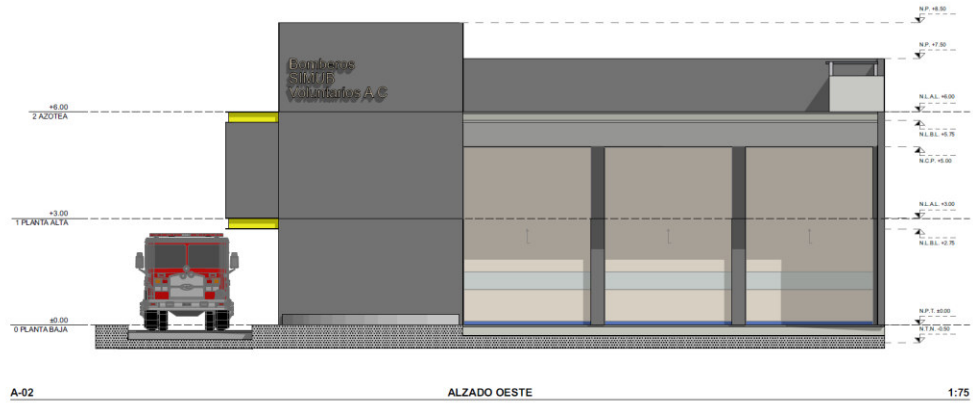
Fachada Oeste. Anteproyecto. Fuente: propia.
